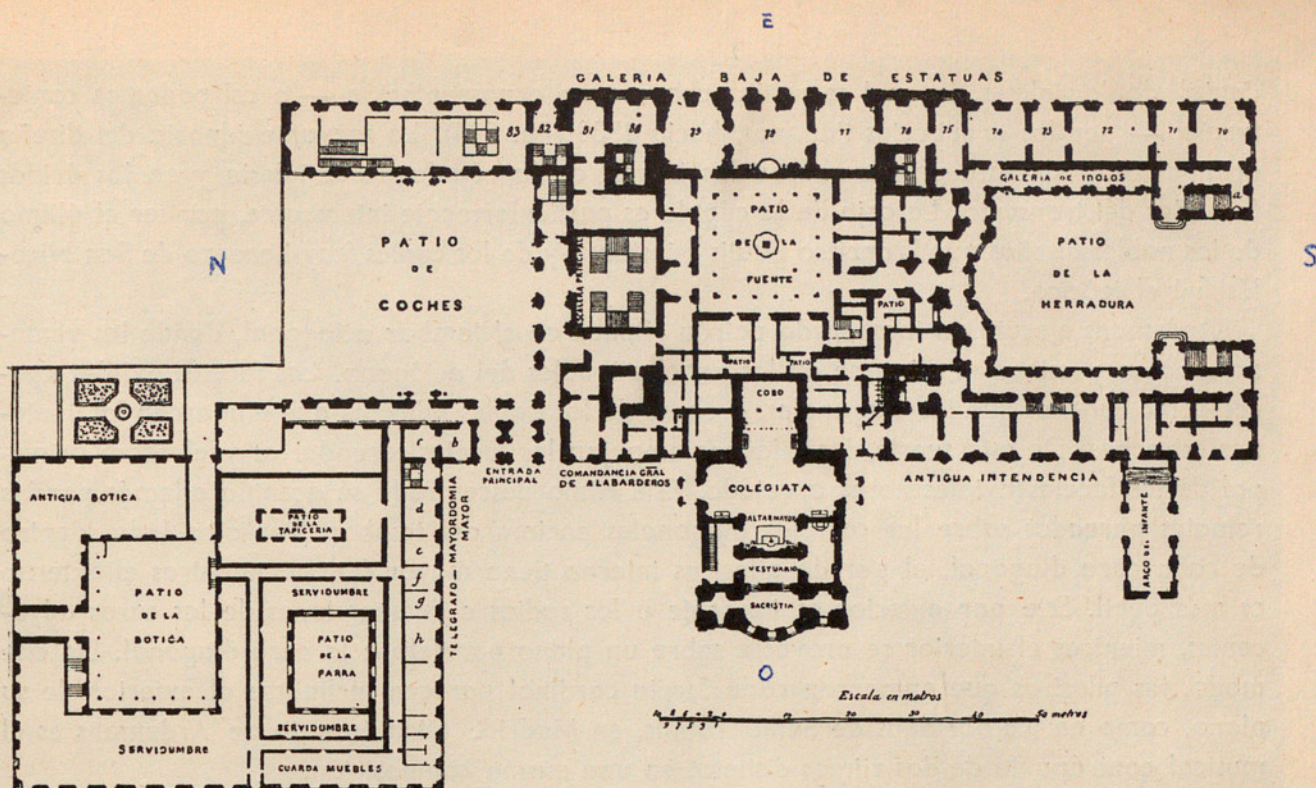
PLANTA BAJA DEL PALACIO DE LA GRANJA. Según Breñosa y Castellarnau.
